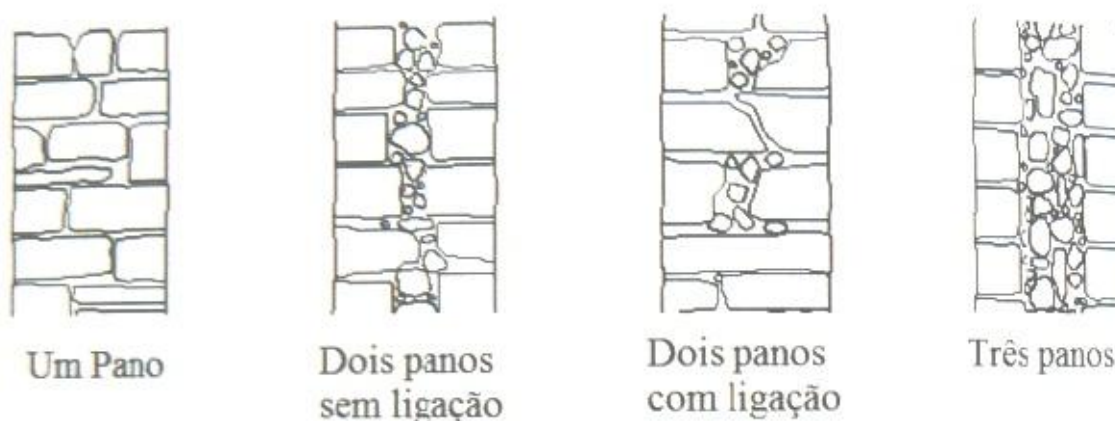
Tipologias de paredes de alvenaria de pedra. [10]
